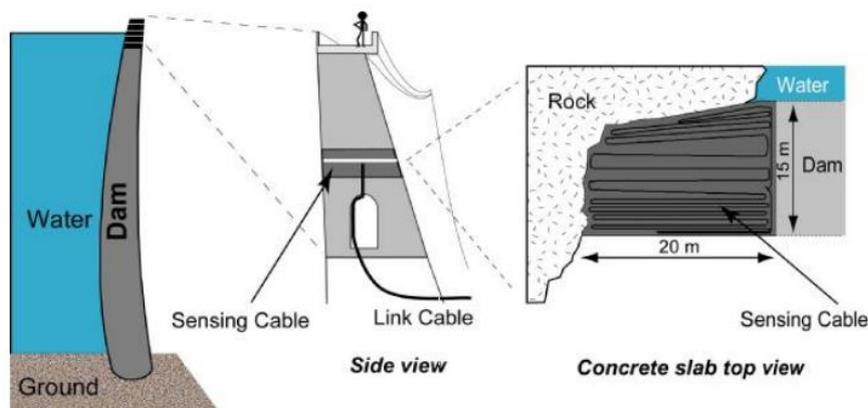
Installation dans un bloc de béton d'un barrage voûte (Source MET-EPFL, Omnisens, SMARTEC).
